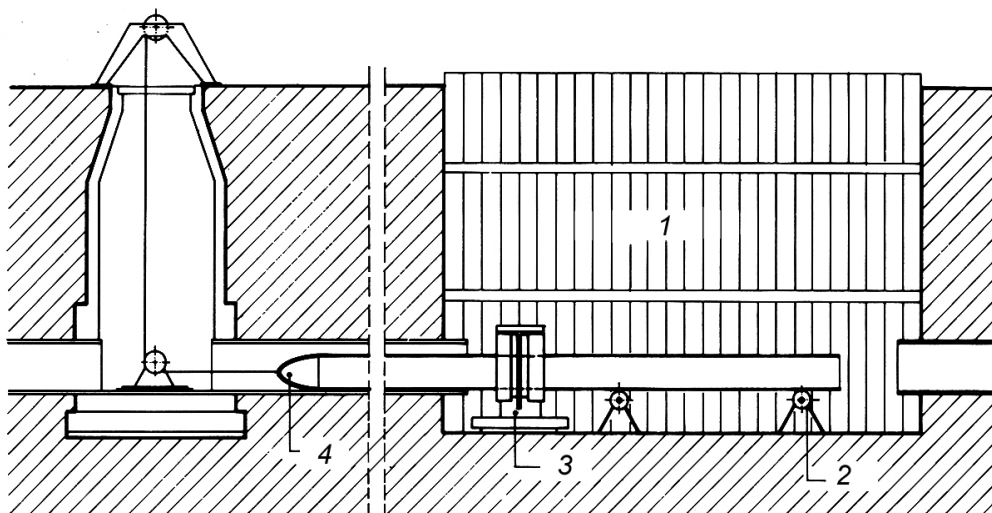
Метод протягивания новых труб в поврежденный трубопровод: 1 – стартовая шахта; 2 – поддерживающие ролики; 3 – сварочный агрегат; 4 – крепежный элемент для троса.
